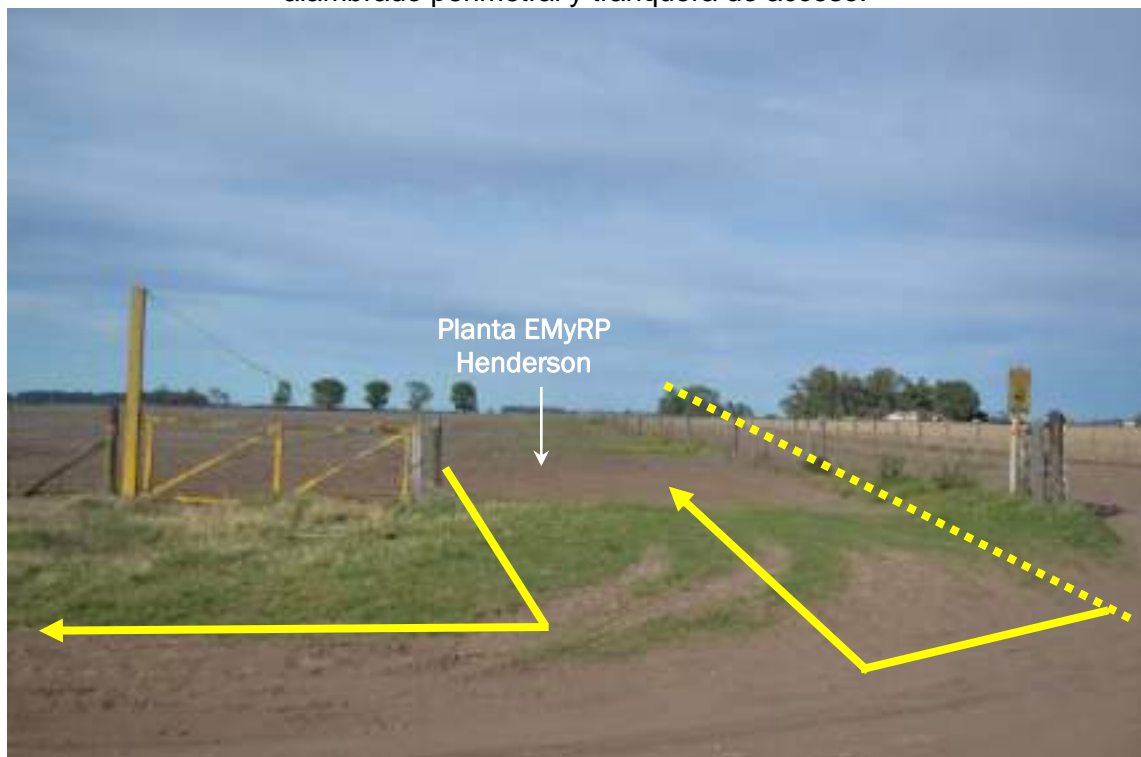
Vista al suroeste. Ídem fotografía anterior a mayor detalle del predio donde se proyecta construir la futura EMyRP Henderson.
